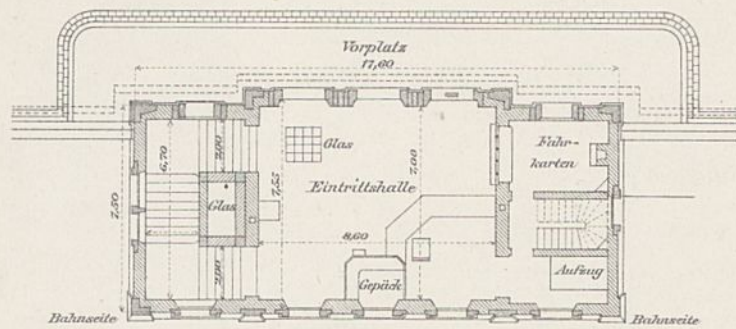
Grundriss in Höhe des Vorplatzes. 1:300.
